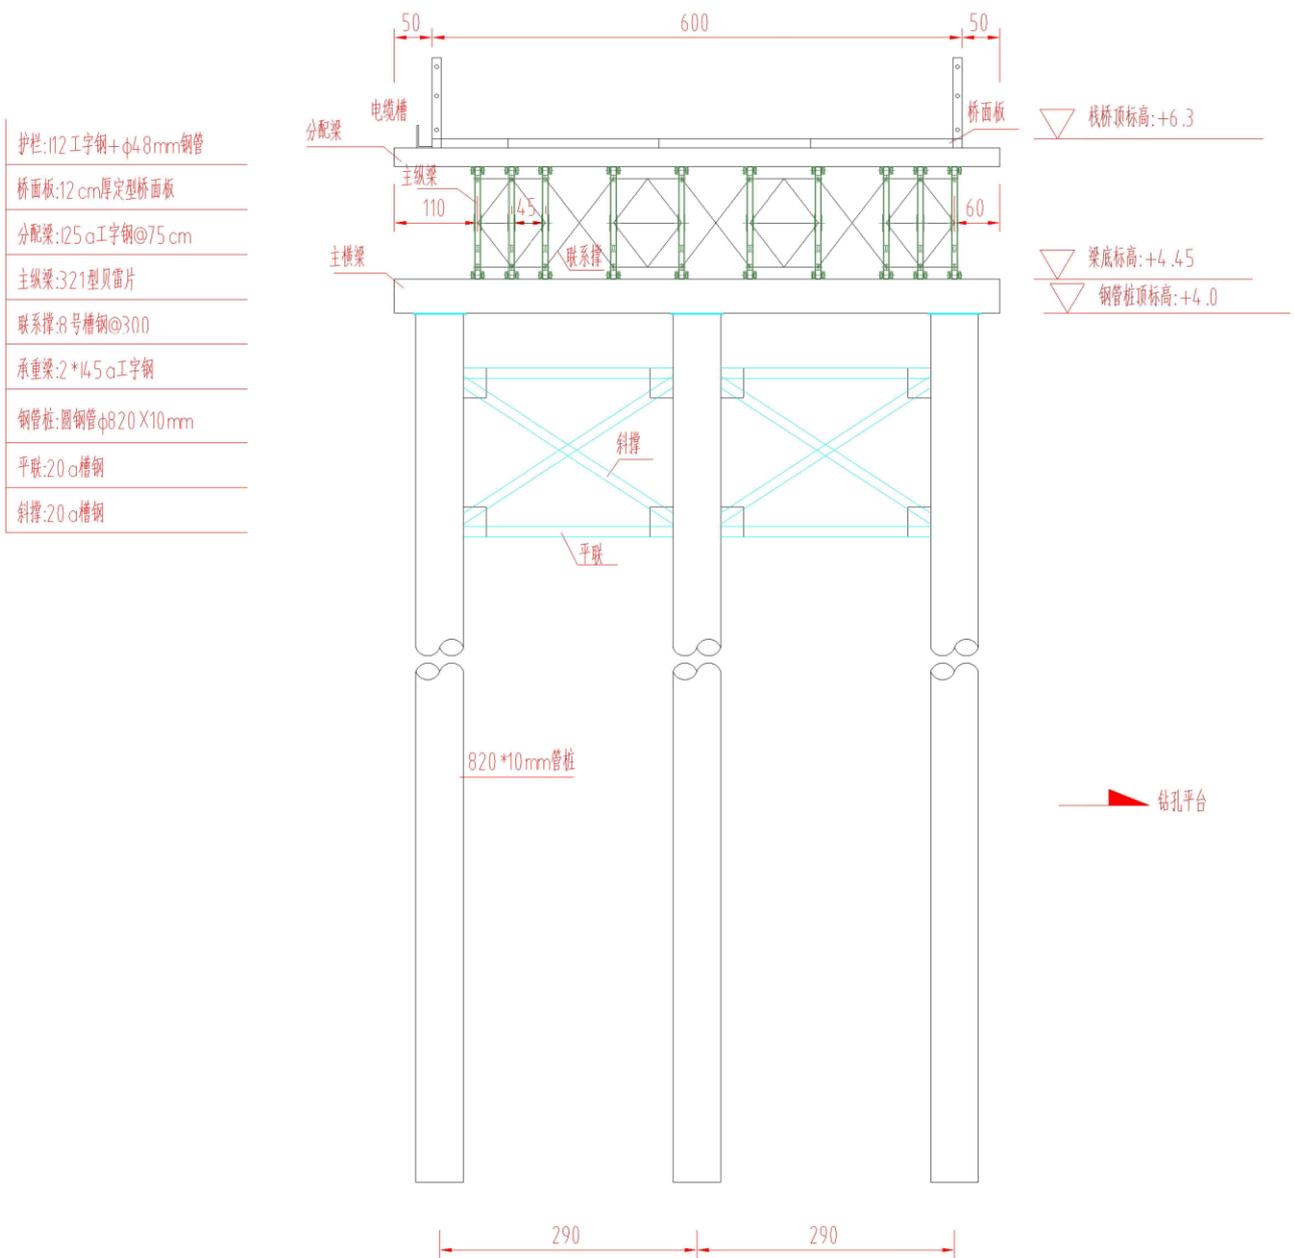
流口大桥施工栈桥（主便道）横断面图
